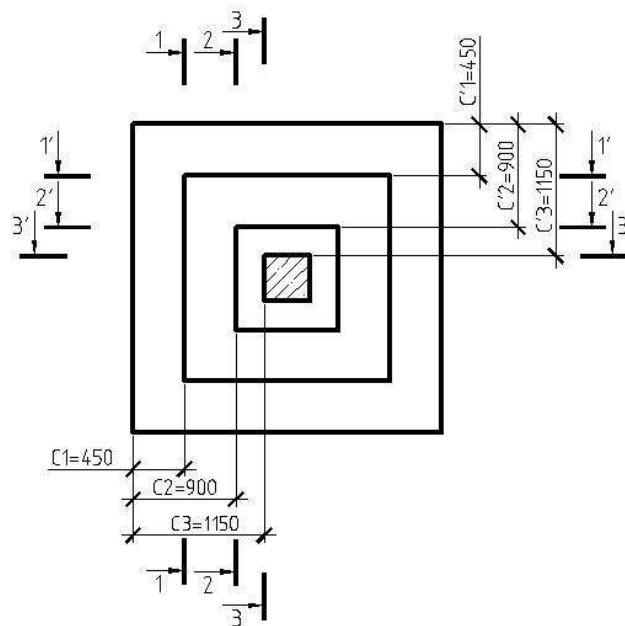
Схема к расчету арматуры плитной части фундамента
